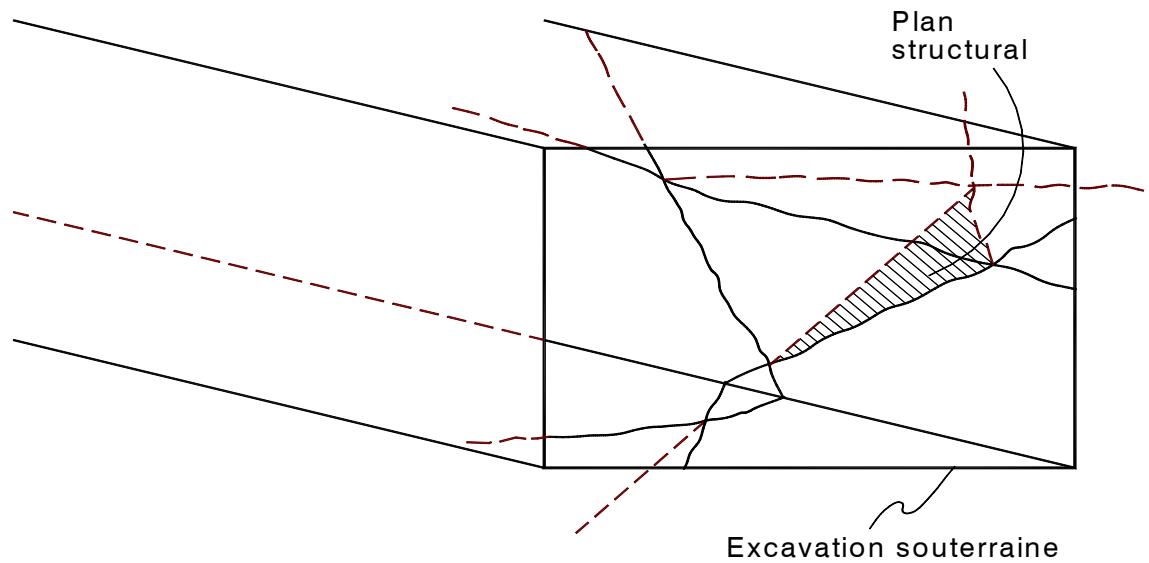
Tétraèdre complètement exposé, formé par trois plans structuraux qui se rencontrent à proximité d'un parement d'une voie horizontale.
